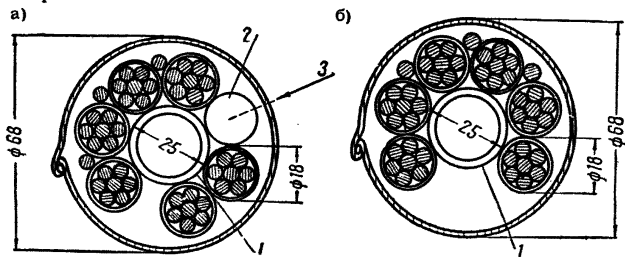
Примерная конструкция сечения мощного арматурного пучка
